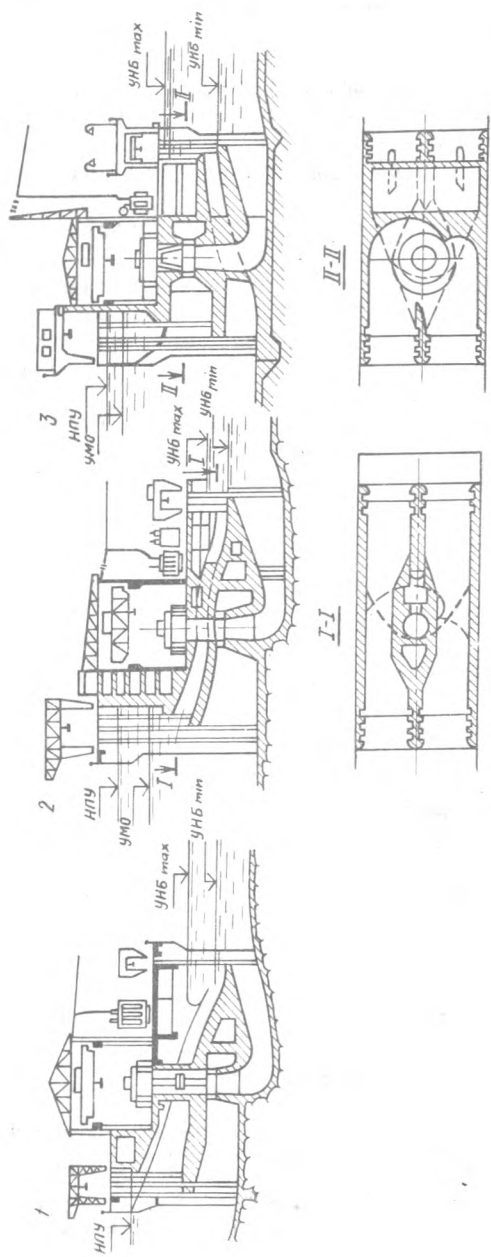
Возможные схемы смещенных зданий ГЭС:
